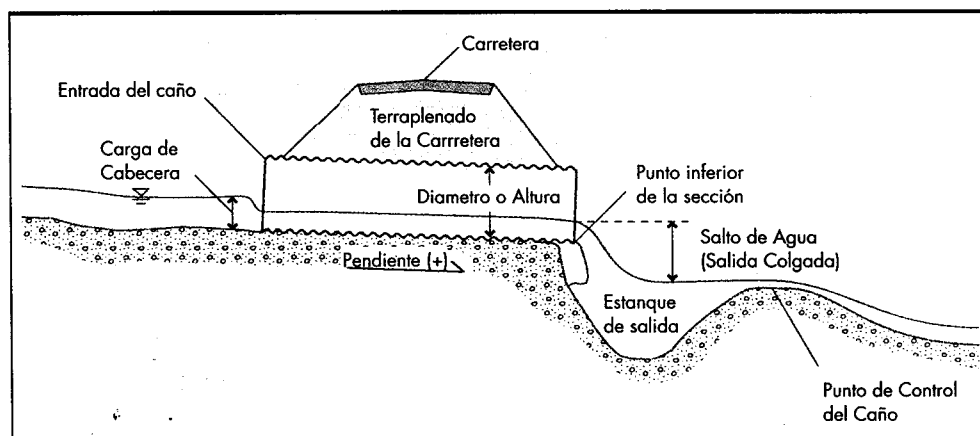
Principales componentes de un caño de drenaje y del cauce.
